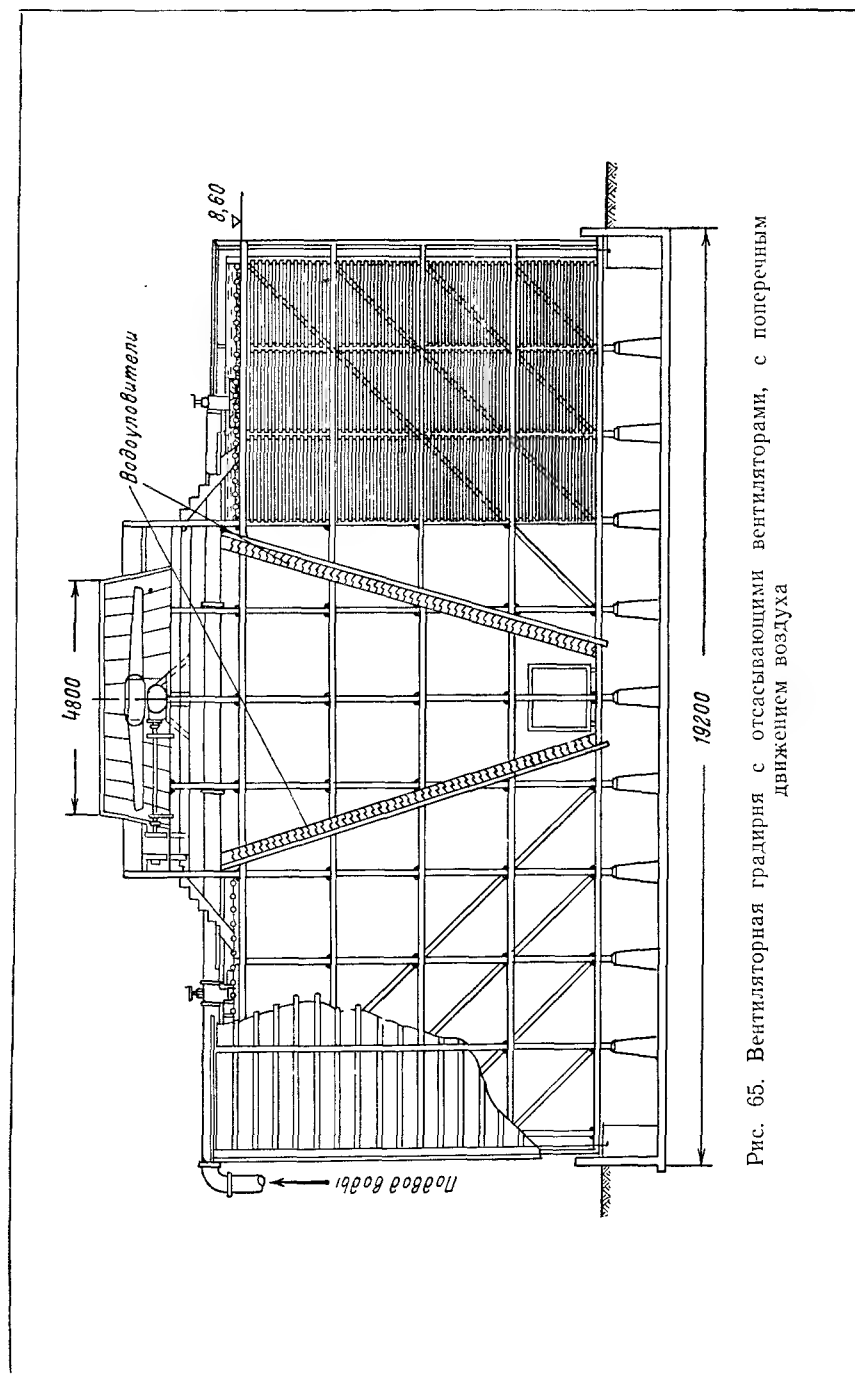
Вентиляторная градирня с отсасывающими вентиляторами, с поперечным движением воздуха
